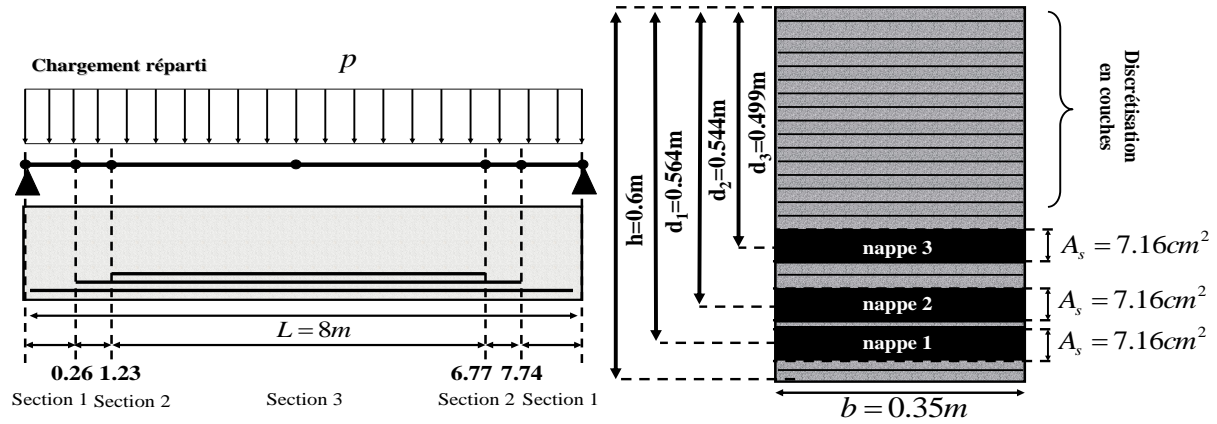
Dimensions, maillage et arrêt des barres de la poutre Figure 14 : Section en béton armé à 3 nappes
